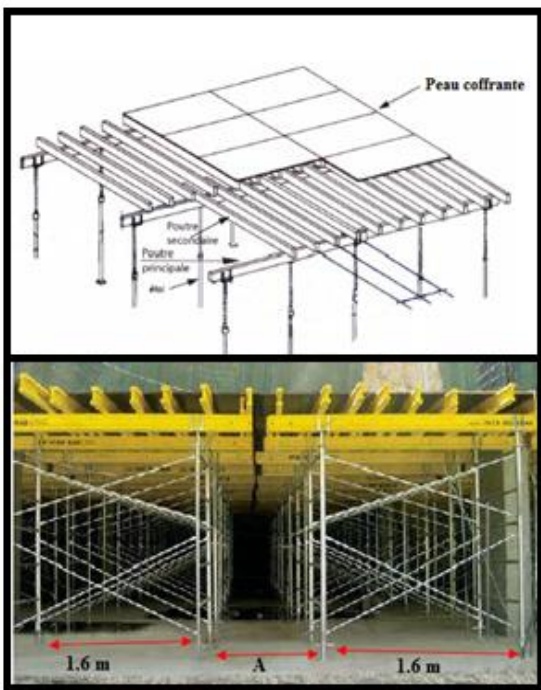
PRINCIPE DU COFFRAGE D'UNE DALLE PLEINE OU EN POST TENSION
